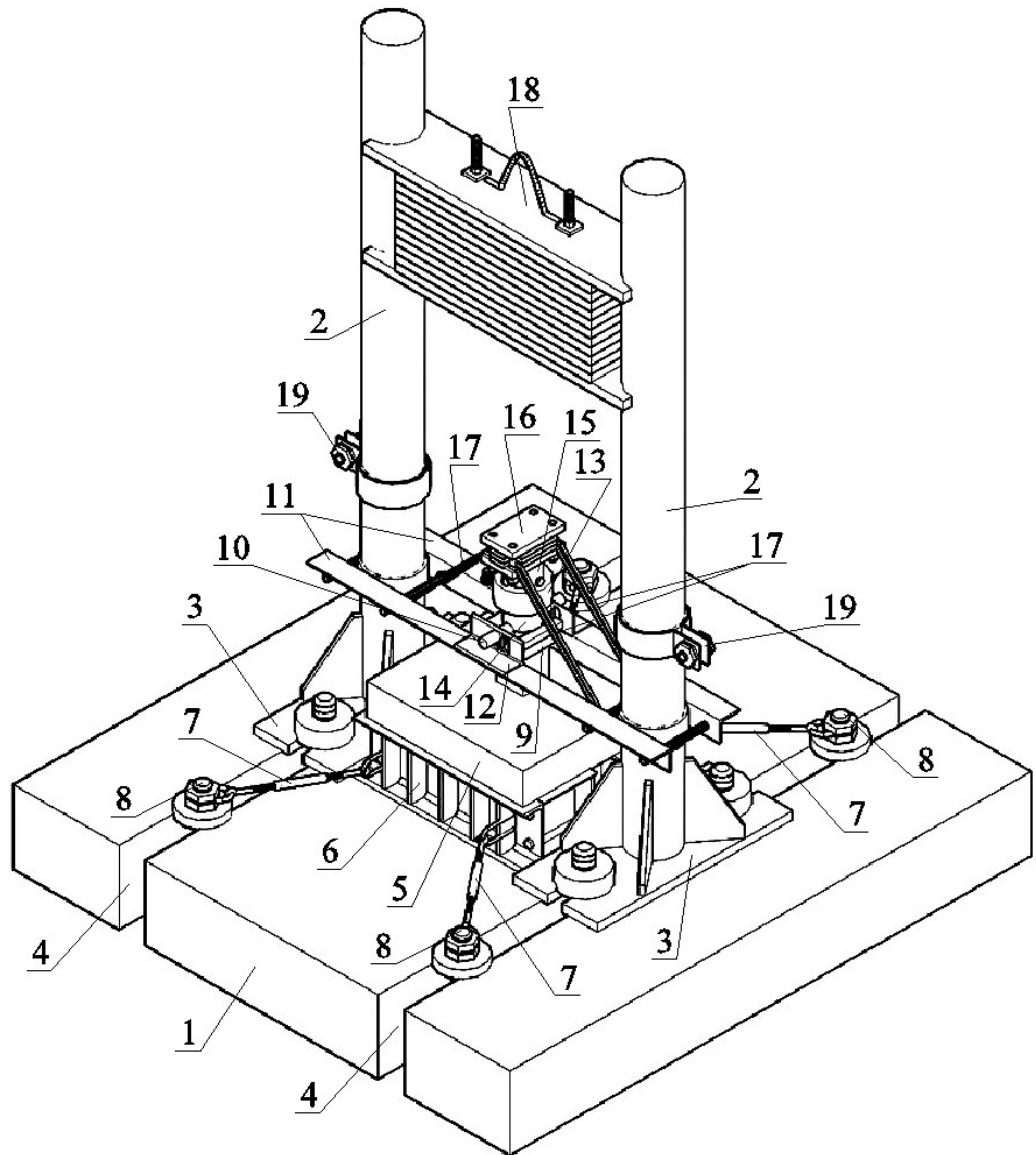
Стенд для проведения испытаний железобетонных элементов при работе на продавливание при кратковременном динамическом нагружении: 1 – силовой пол; 2 – стойки копра; 3 – база для крепления стоек копра к силовому полу; 4 – каналы силового пола; 5 – плита образца; 6 – опорный контур для плиты; 7-8 – крепление опорного контура; 9,10,11,12 – крепления динамометра; 13 – датчик ускорений; 14 – динамометр; 15,16,17 – приспособления для центрирования и фиксации динамометра; 18 – строповочная петля для груза; 19 – стопор для груза
